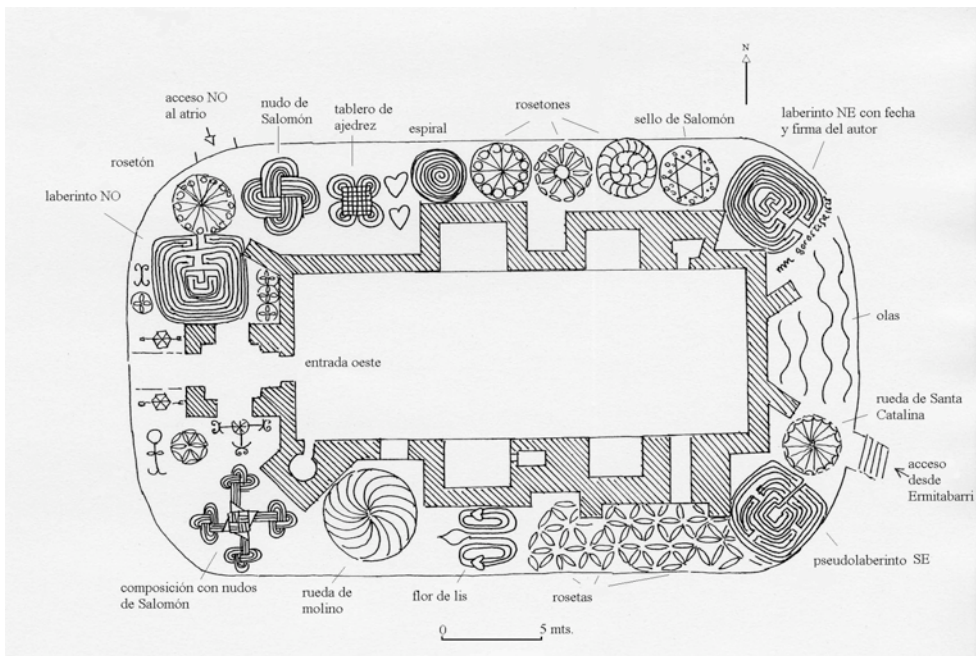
Plano del empedrado de Santo Tomás de Olabarrieta (Zeberio)
